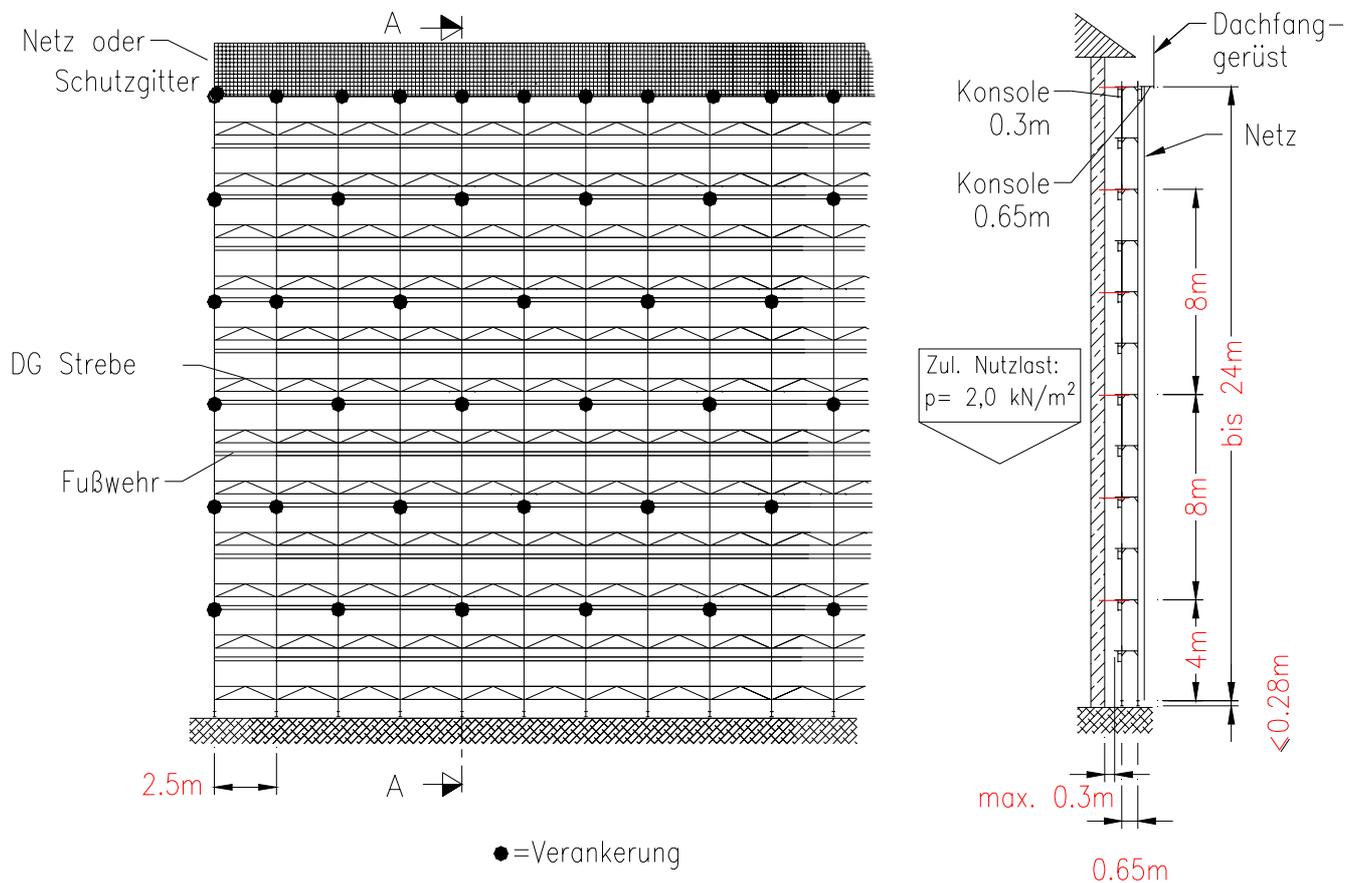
Netzbekl.Grundkonfiguration vor geschlossener Fassade
